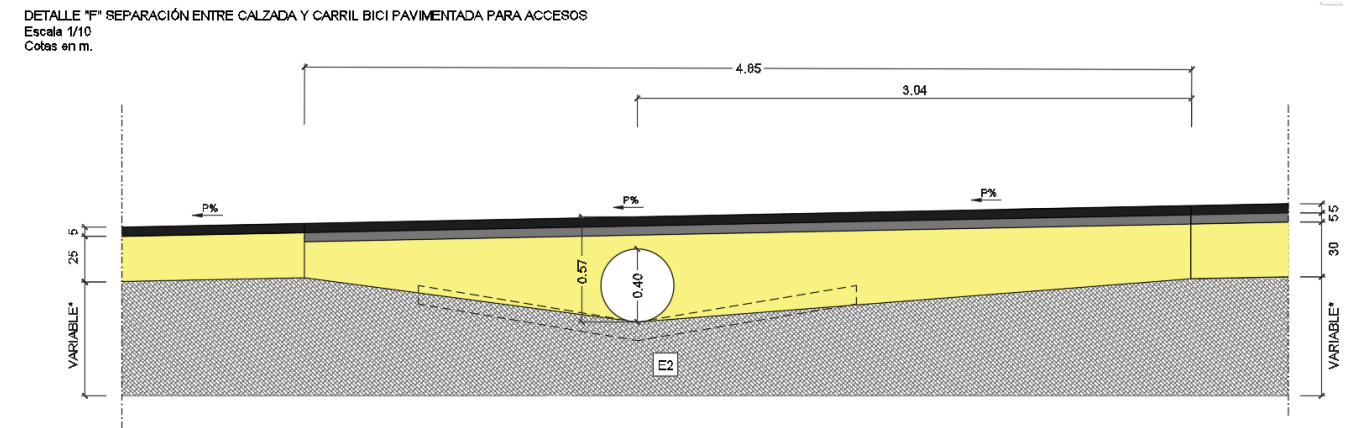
Drenaje en pasos salvacunetas y bajo pavimento en accesos.
